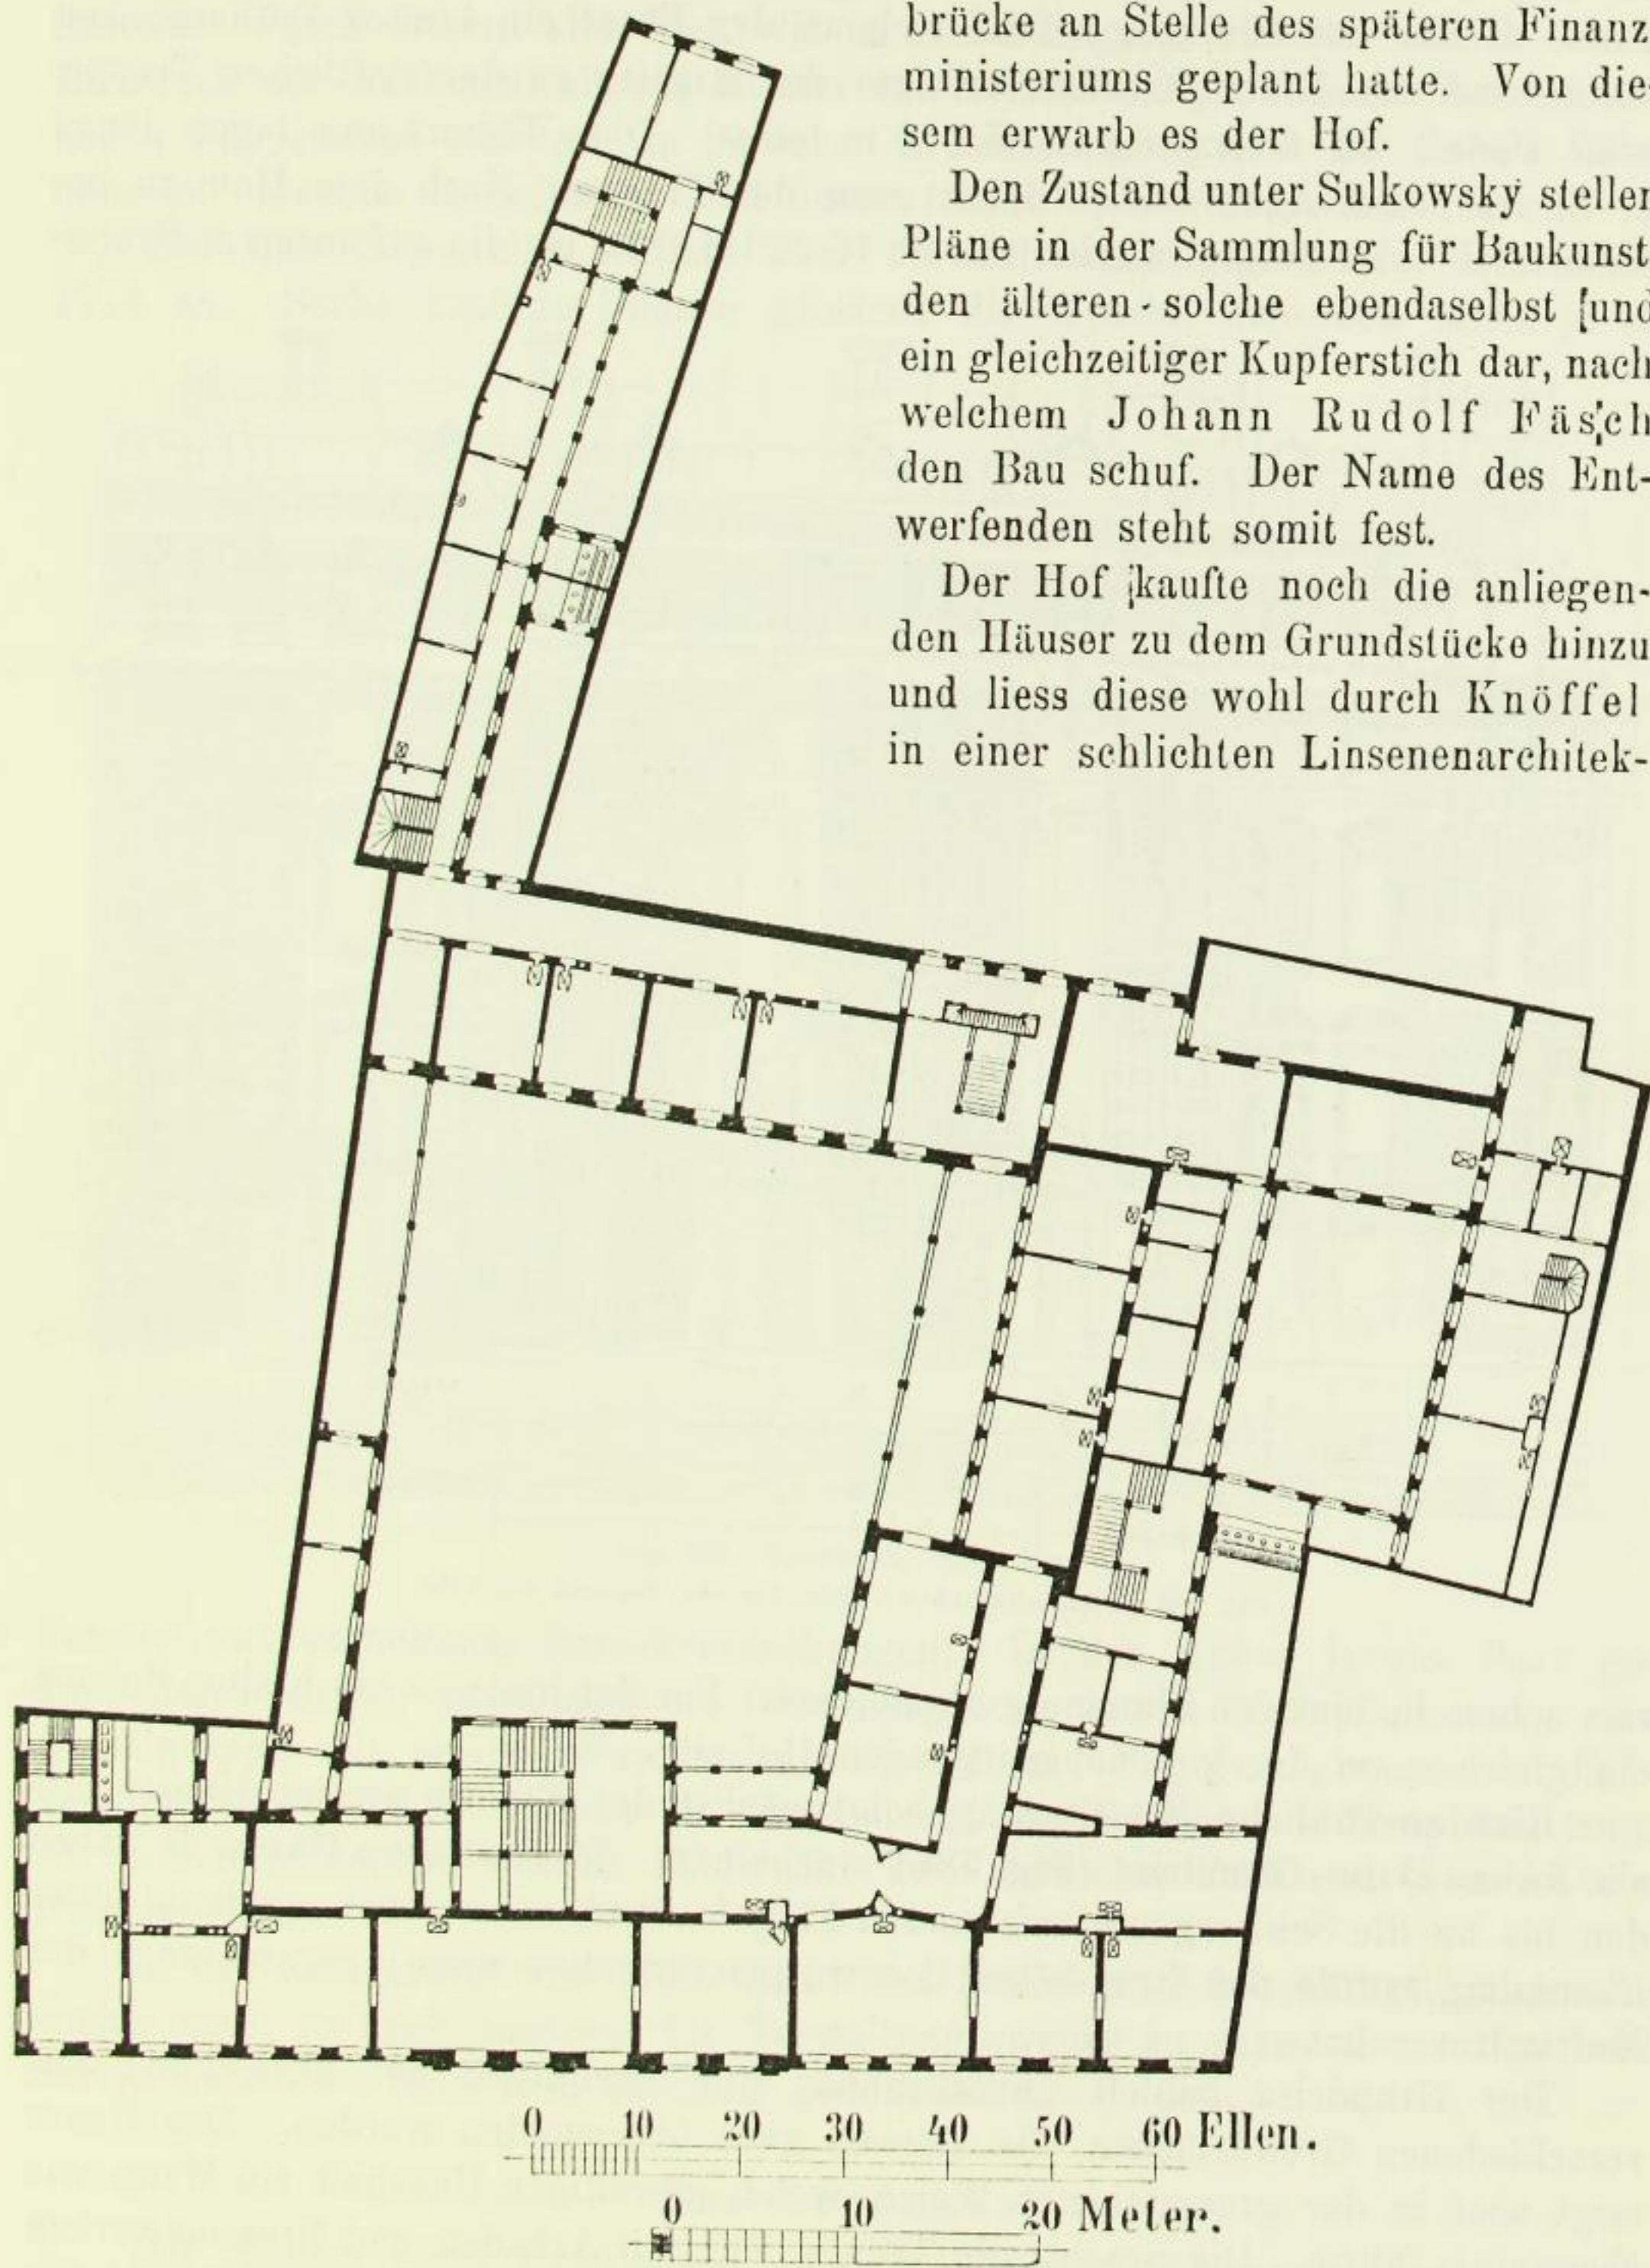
Flemming'sches Palais, Grundriss des I. Obergeschosses. Zustand von 1747.
